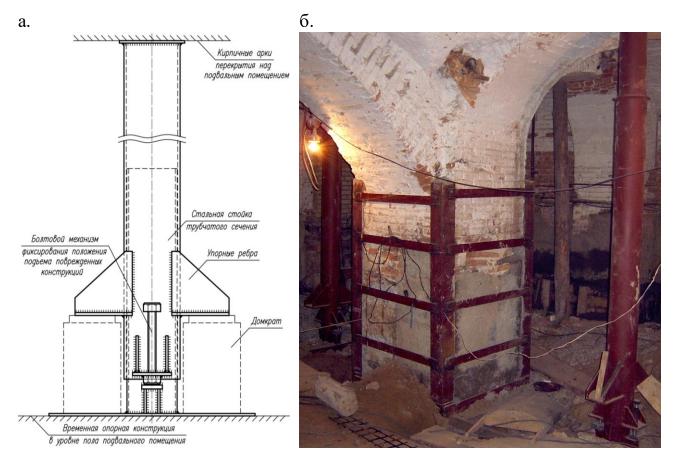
Временные стальные стойки силовой подъемной системы а — конструкция стойки; б — фрагмент восстановительных работ
